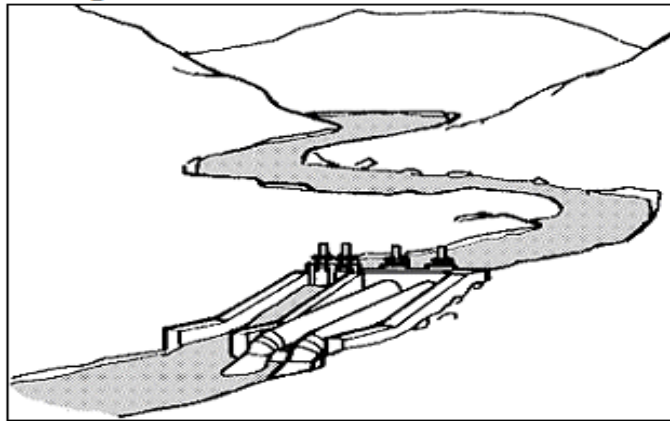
Central encastrada na barragem, queda baixa com central na própria barragem
